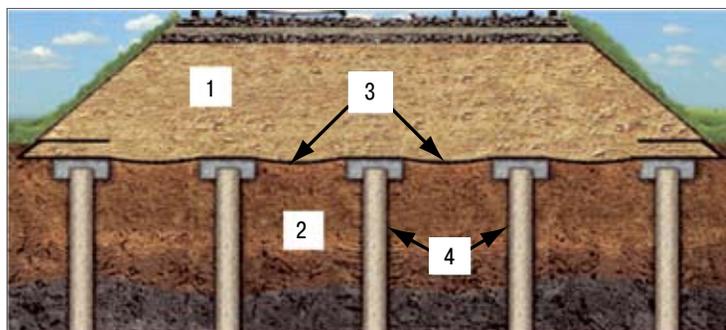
Принципиальная конструкция из вертикальных несущих элементов и гибкого ростверка для усиления основания насыпи (1 — земляное полотно; 2 — толща слабого грунта; 3 — геосинтетический материал (тканые георешетка или геополотно на основе ПВХ или ПЭТ); 4 — сваи)
